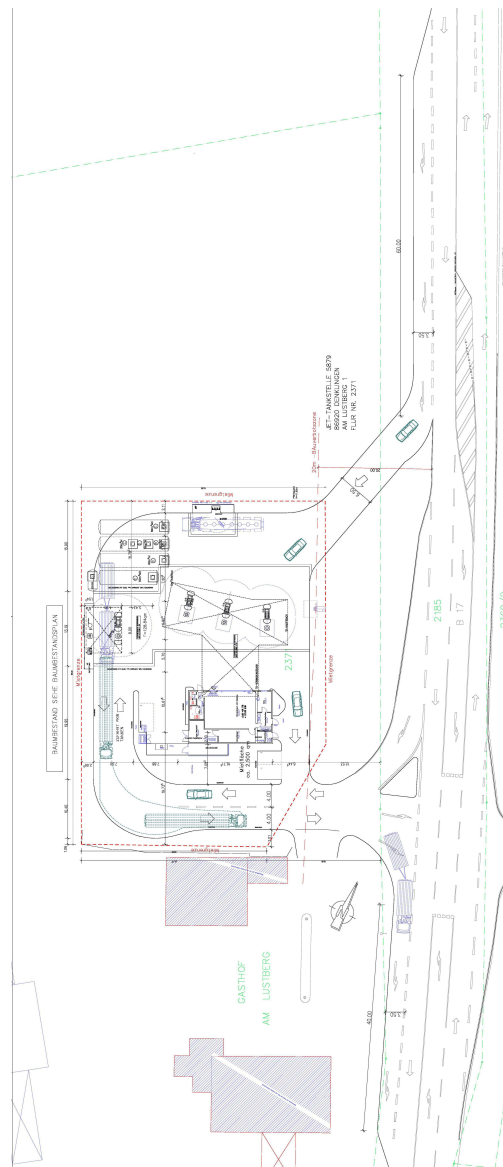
Lageplan der verkehrlichen Erschließung der geplanten Tankstellenanlage im Bereich Lustberg
